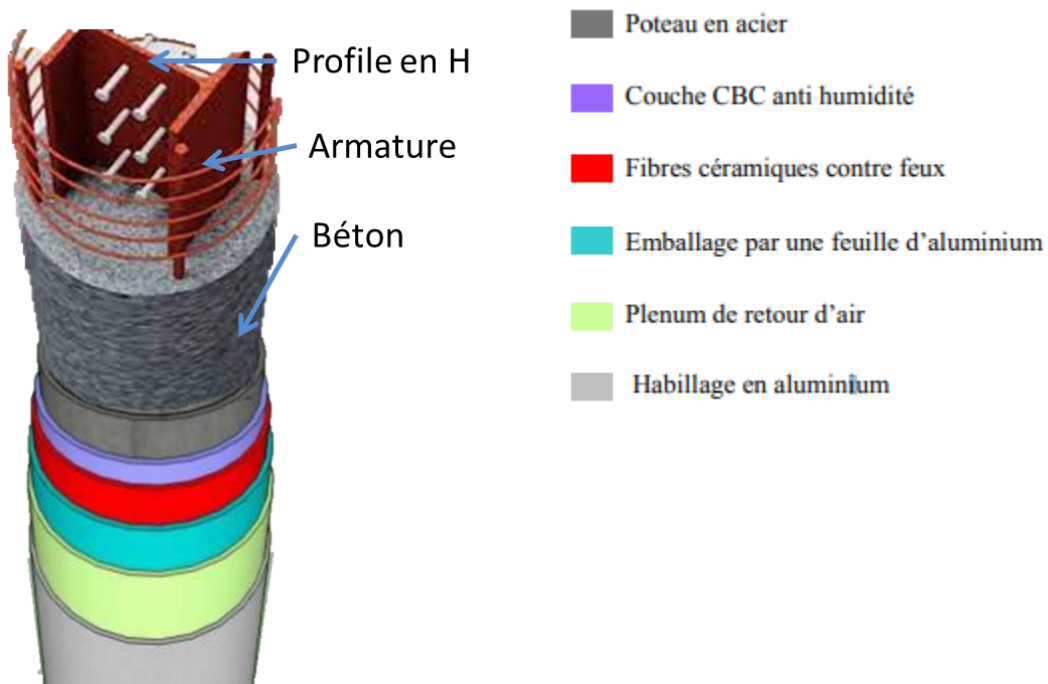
revêtement d'un poteau tubulaire mixte. Source : auteurs.
